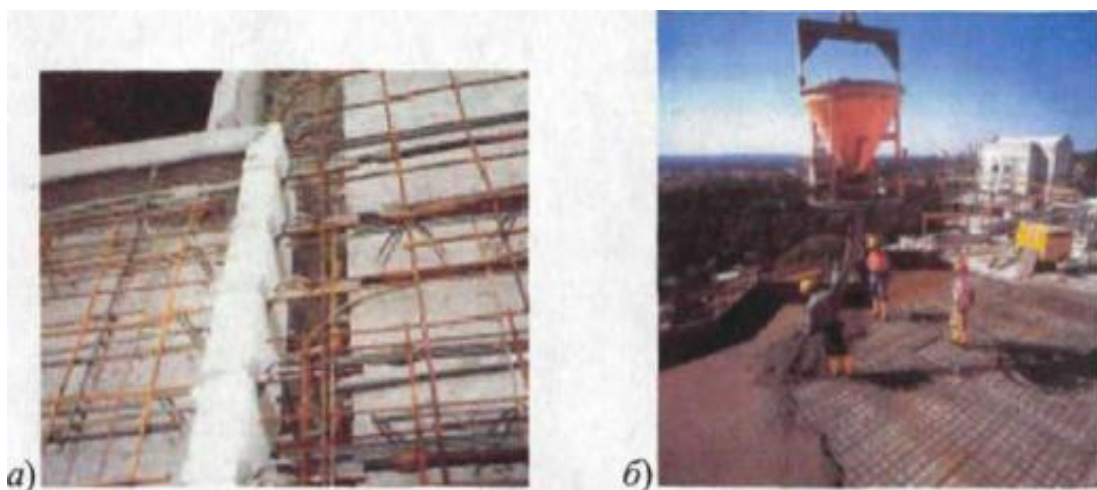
Збірно-монолітні перекриття з незнімною опалубкою, а - пару плити перекриття з консольною плитою балкона, б - укладання монолітного бетону в плиту перекриття по незнімній опалубці
